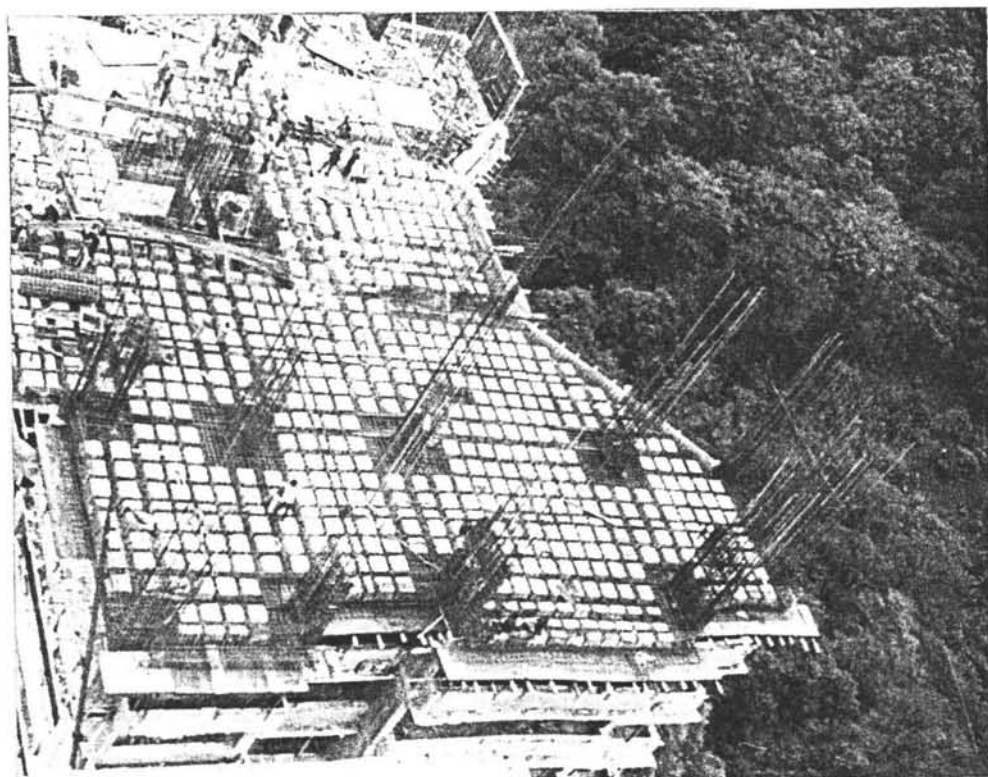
Vista de Torre Esmeralda de una losa reticular en construcción.
